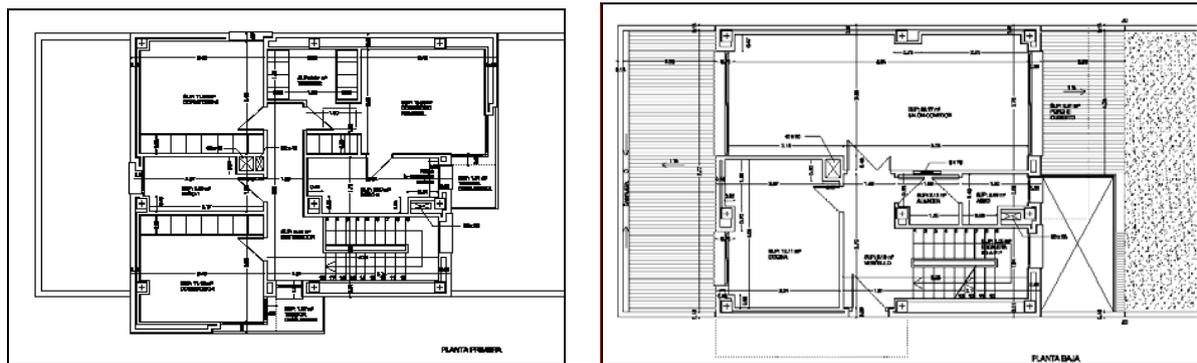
y 2. Planta primera (izquierda) y planta baja (derecha)
